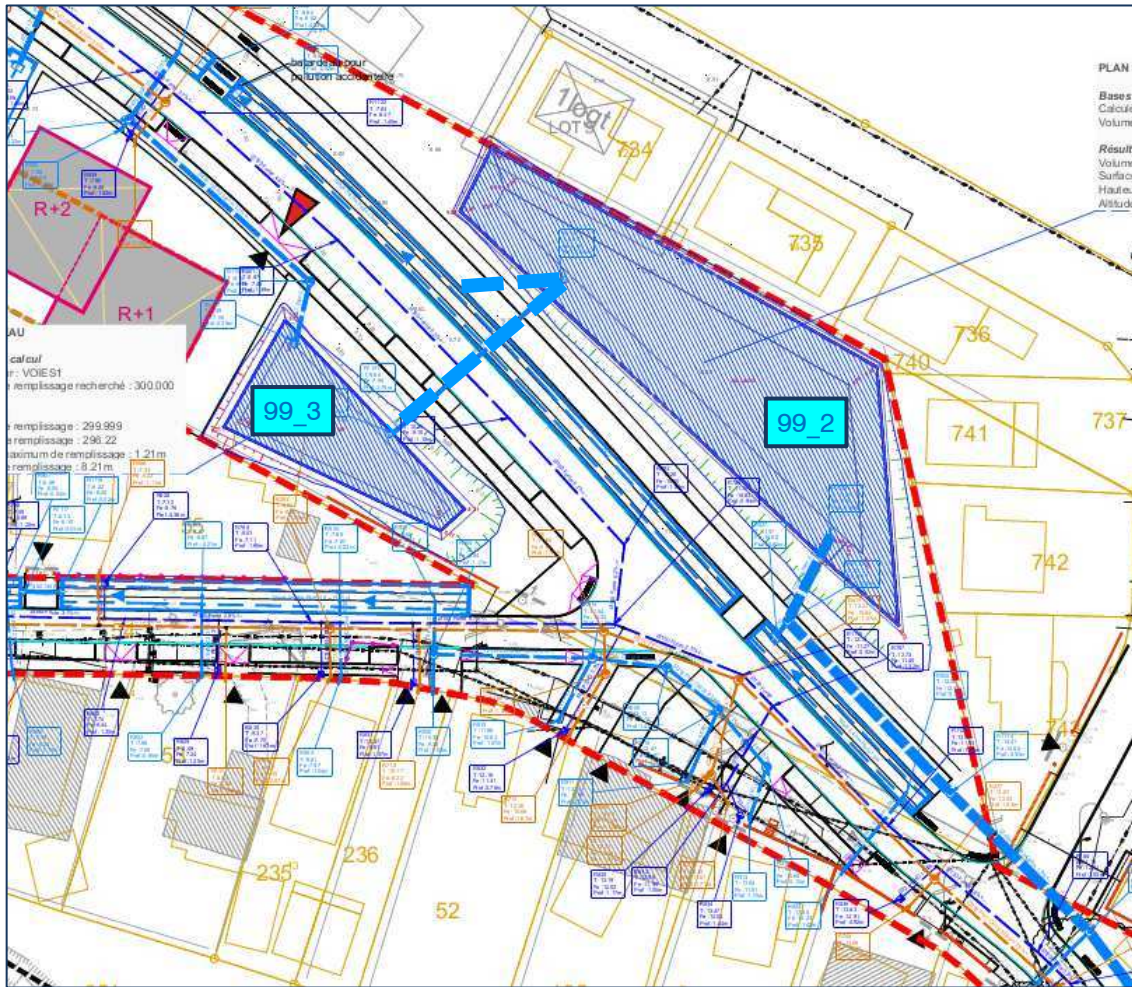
extrait du plan projet du bassin 99\_2 + 99\_3 (planche A)
